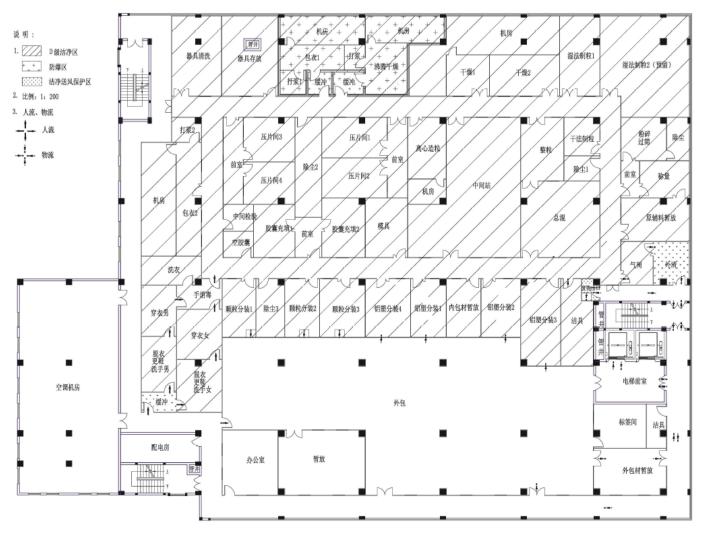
本项目变动前综合制剂生产车间二层平面布置图
